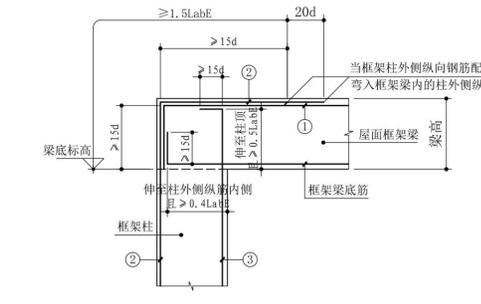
屋面框架梁纵向钢筋在顶层端支座构造大样
